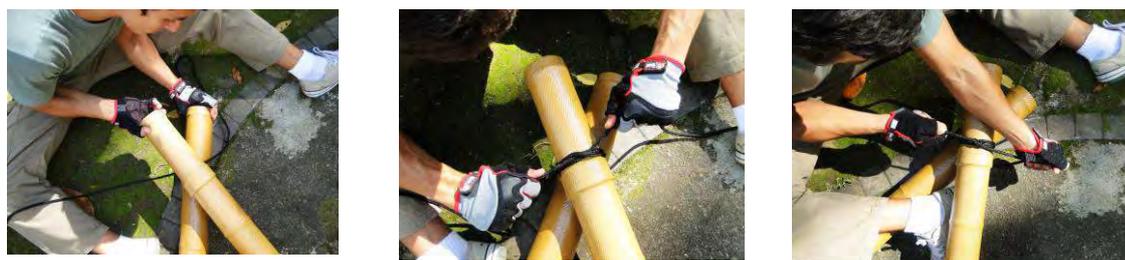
e 14 – Fabricação de módulo de casca reticulada utilizando ligações amarradas.
